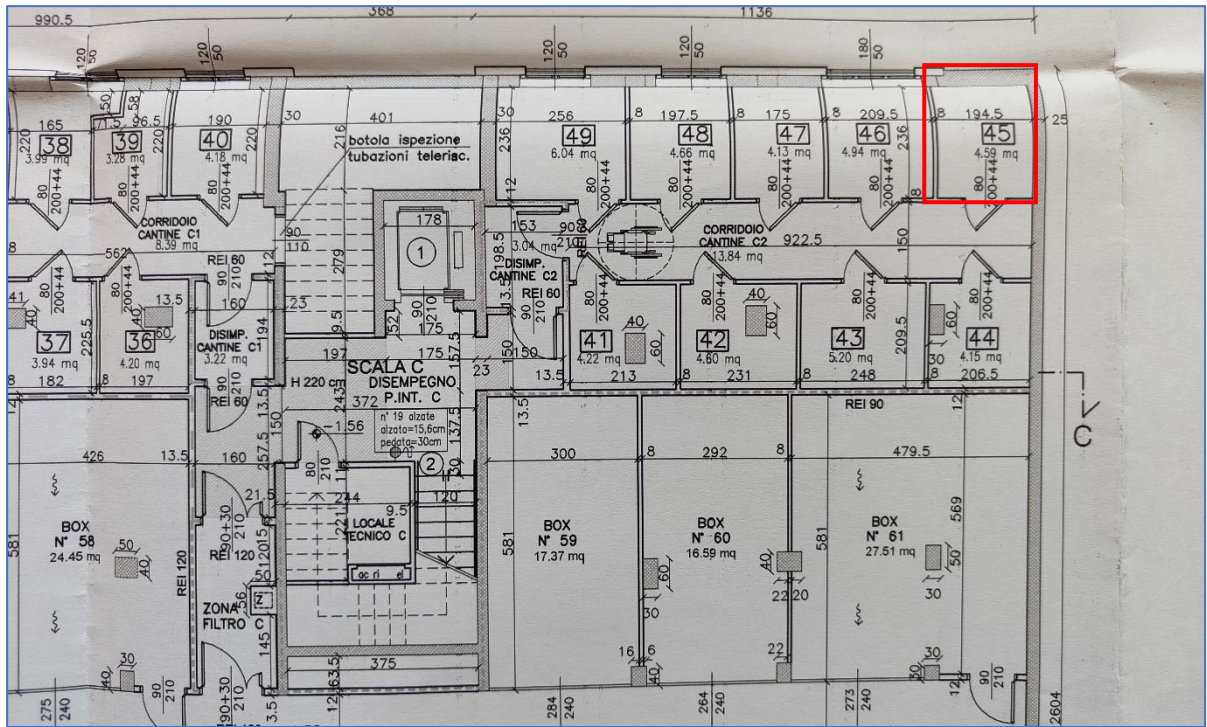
Estratto di progetto Pratica 63/2013 - cantina
